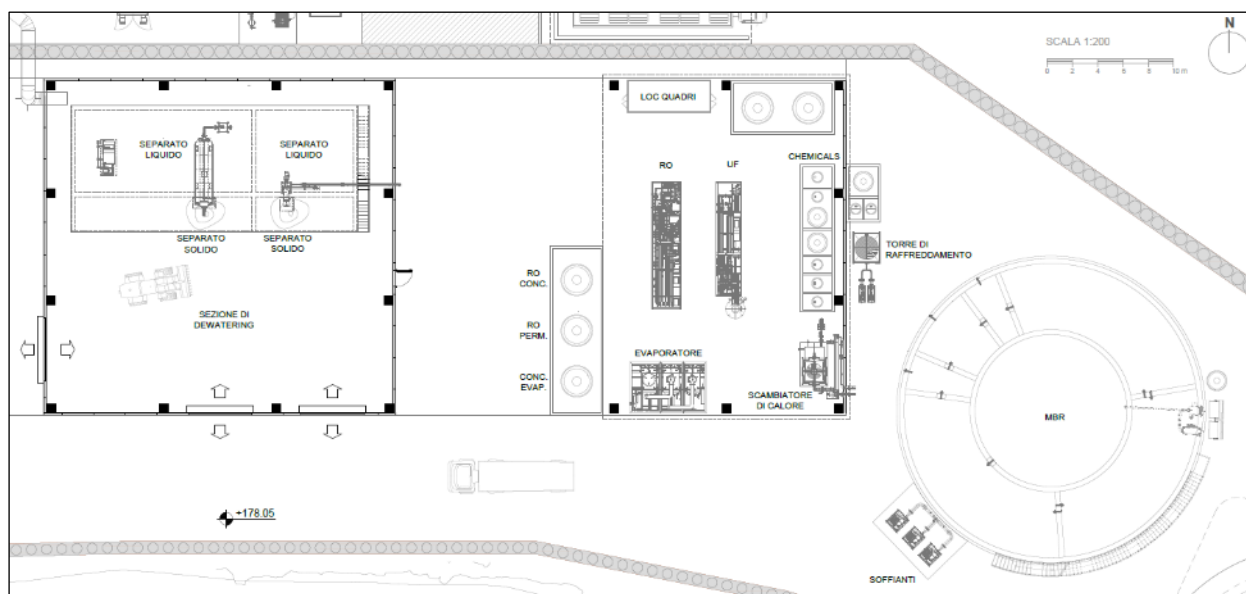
Layout impiantistico della sezione di depurazione del digestato
